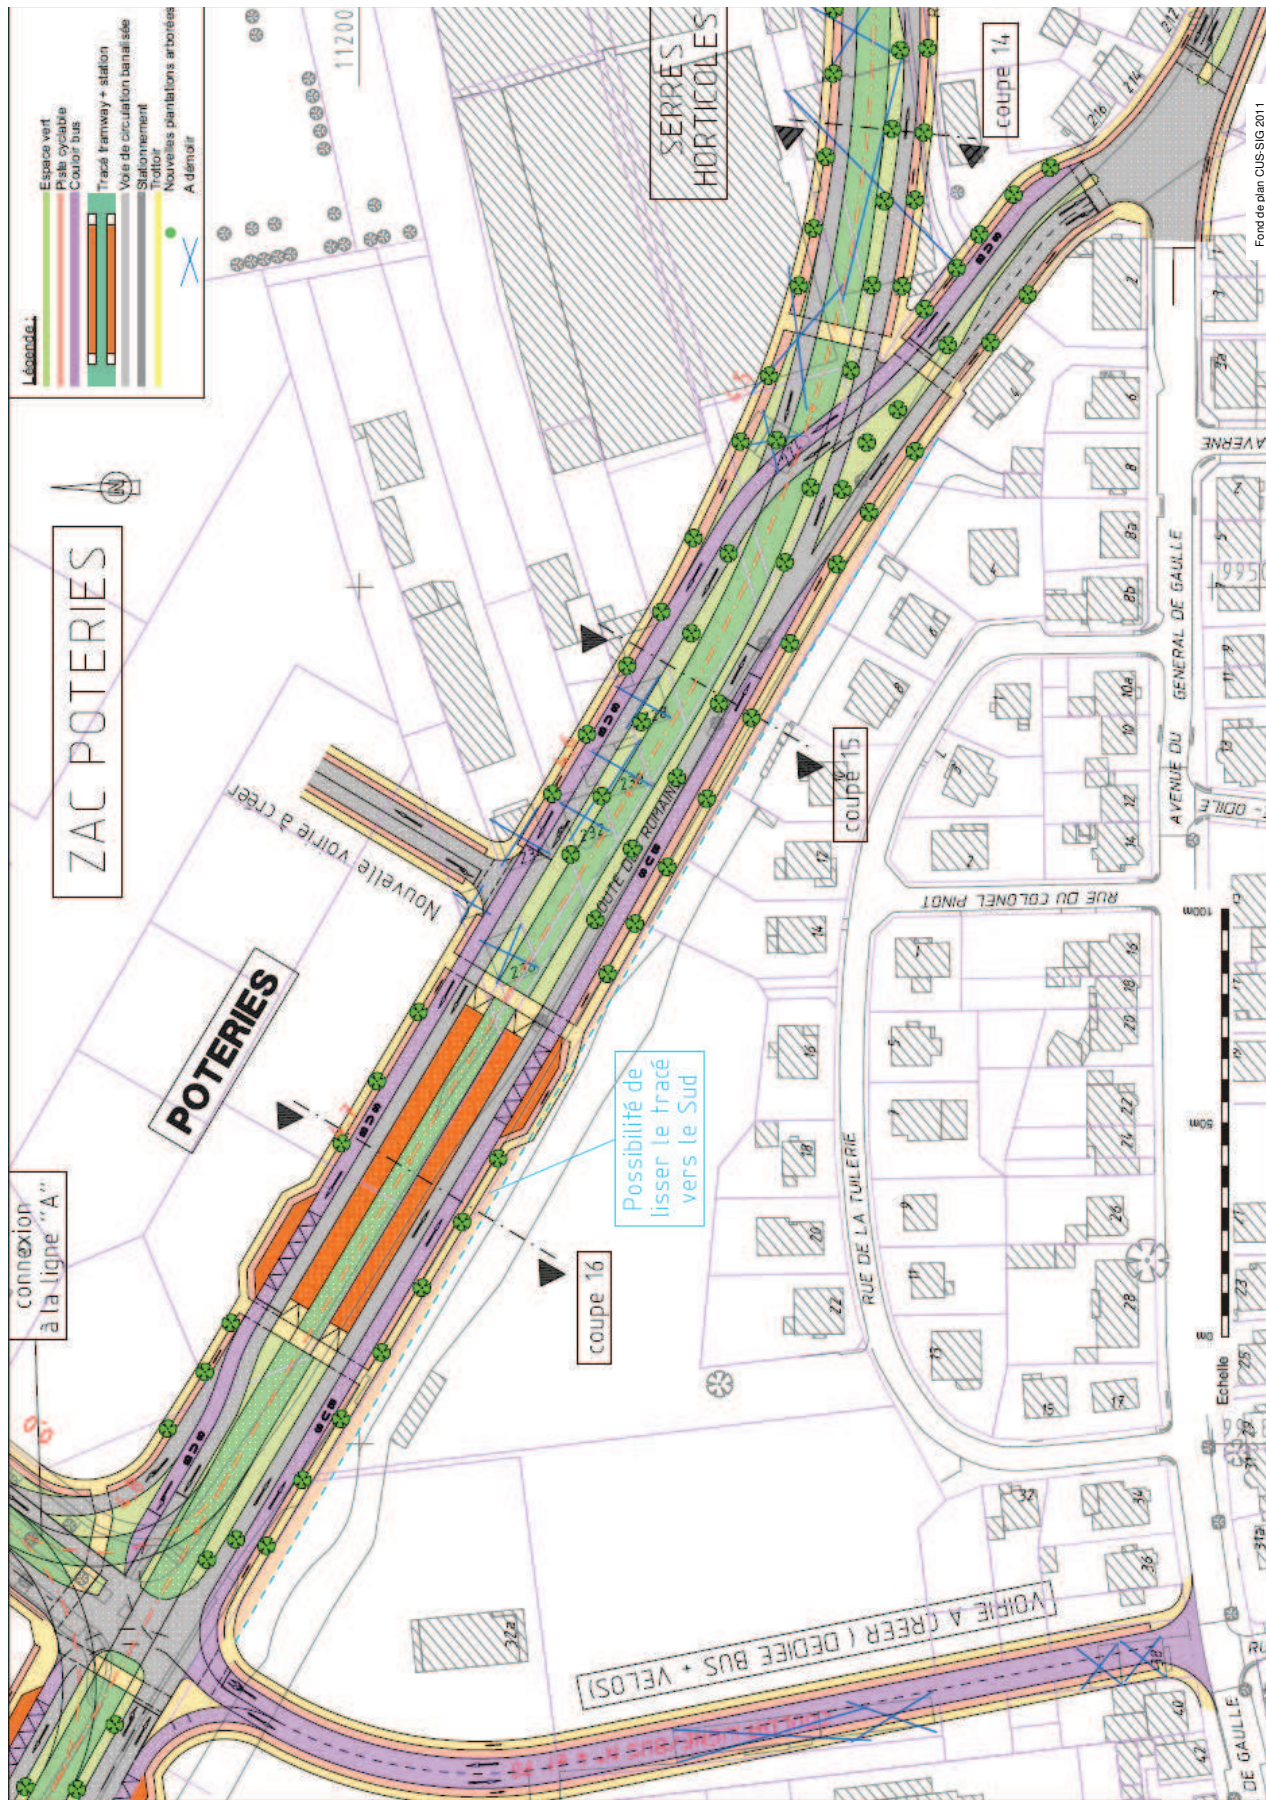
Plan zoom sur secteur "Romains / Mitterrand", variante "couloirs bus"
